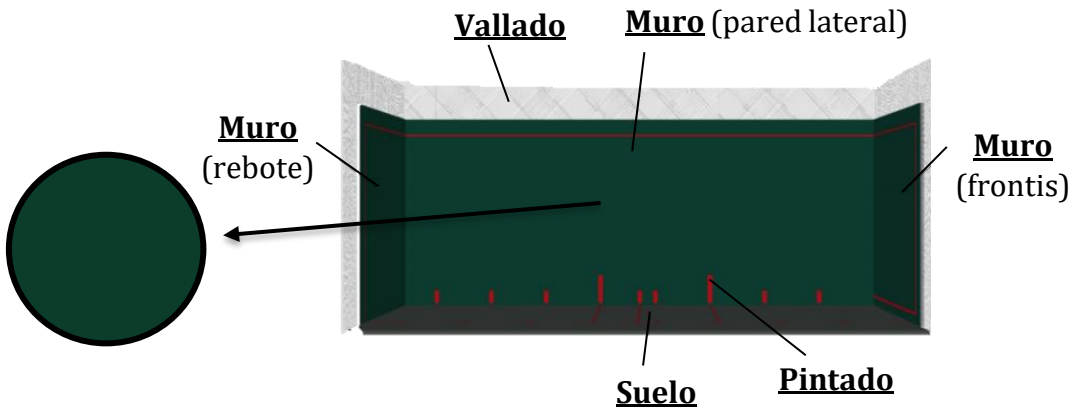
Fase 1 del frontón cubierto con pared de hormigón
